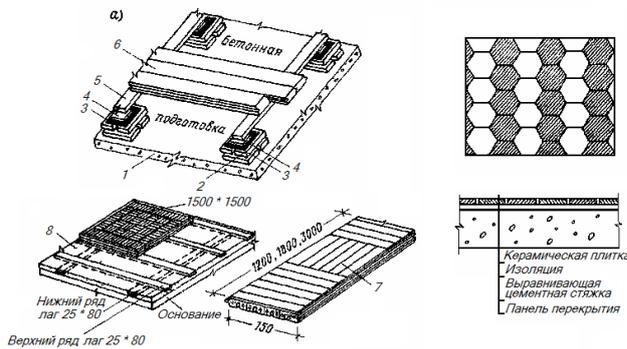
Полы жилых и общественных зданий: 1 – основание; 2 – кирпичные столбики; 3 – гидроизоляция; 4 – выравнивающие подкладки; 5 – лаги; 6 – доски; 7 – паркет; 8 – утеплитель–звукоизоляция
